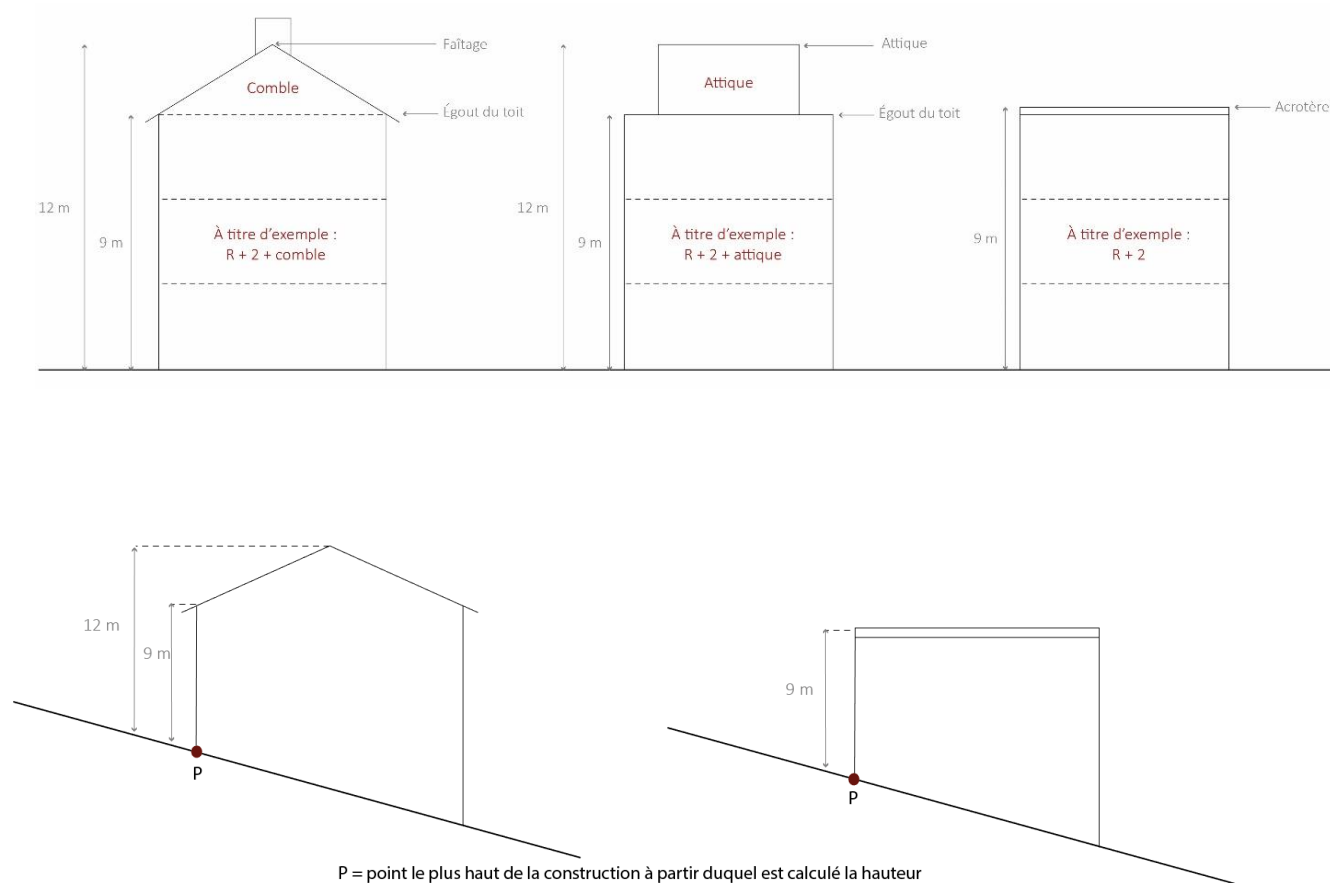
\_ Hauteur maximale autorisée dans la zone 1UAa
